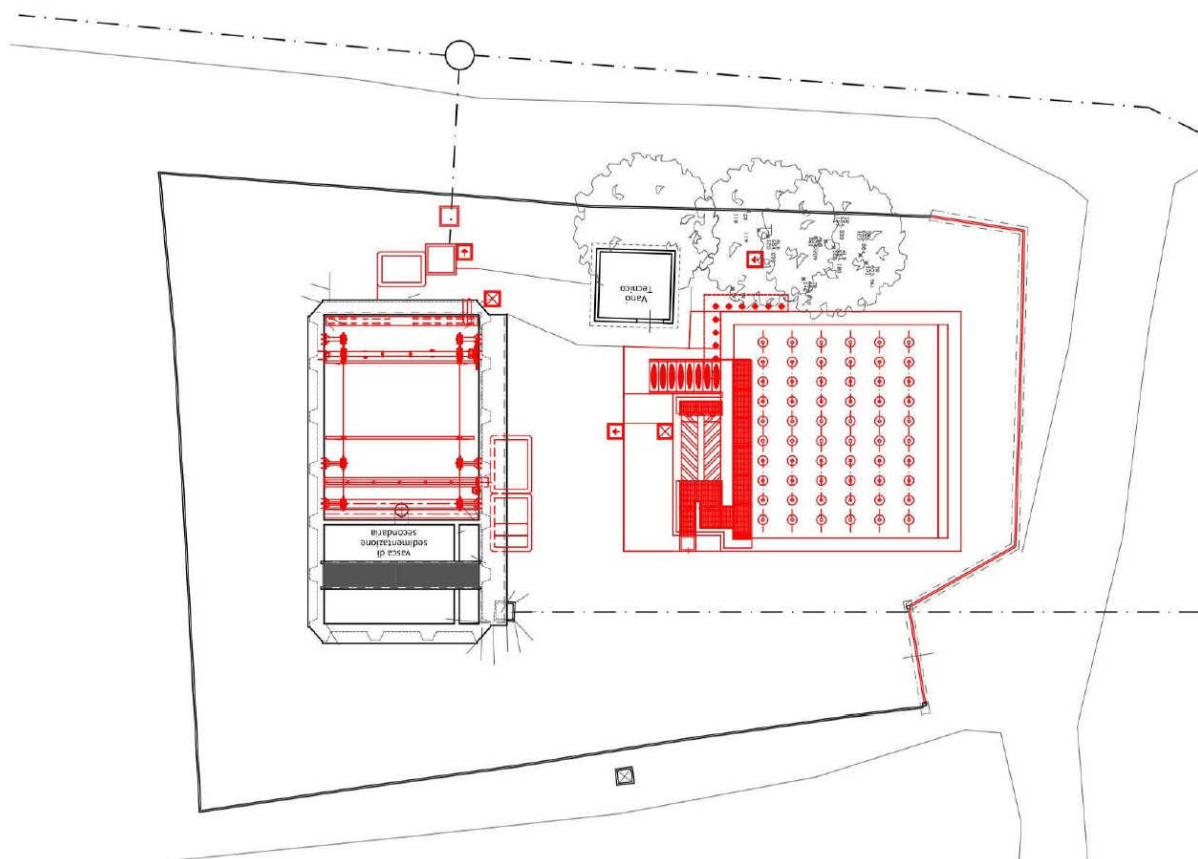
Planimetria dell'impianto a progetto (in rosso le nuove opere)
